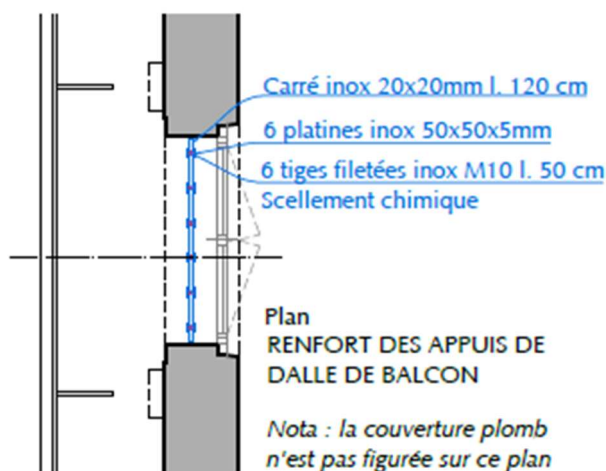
Coupe d'un balcon, mise en évidence du renforcement des appuis de dalle.
